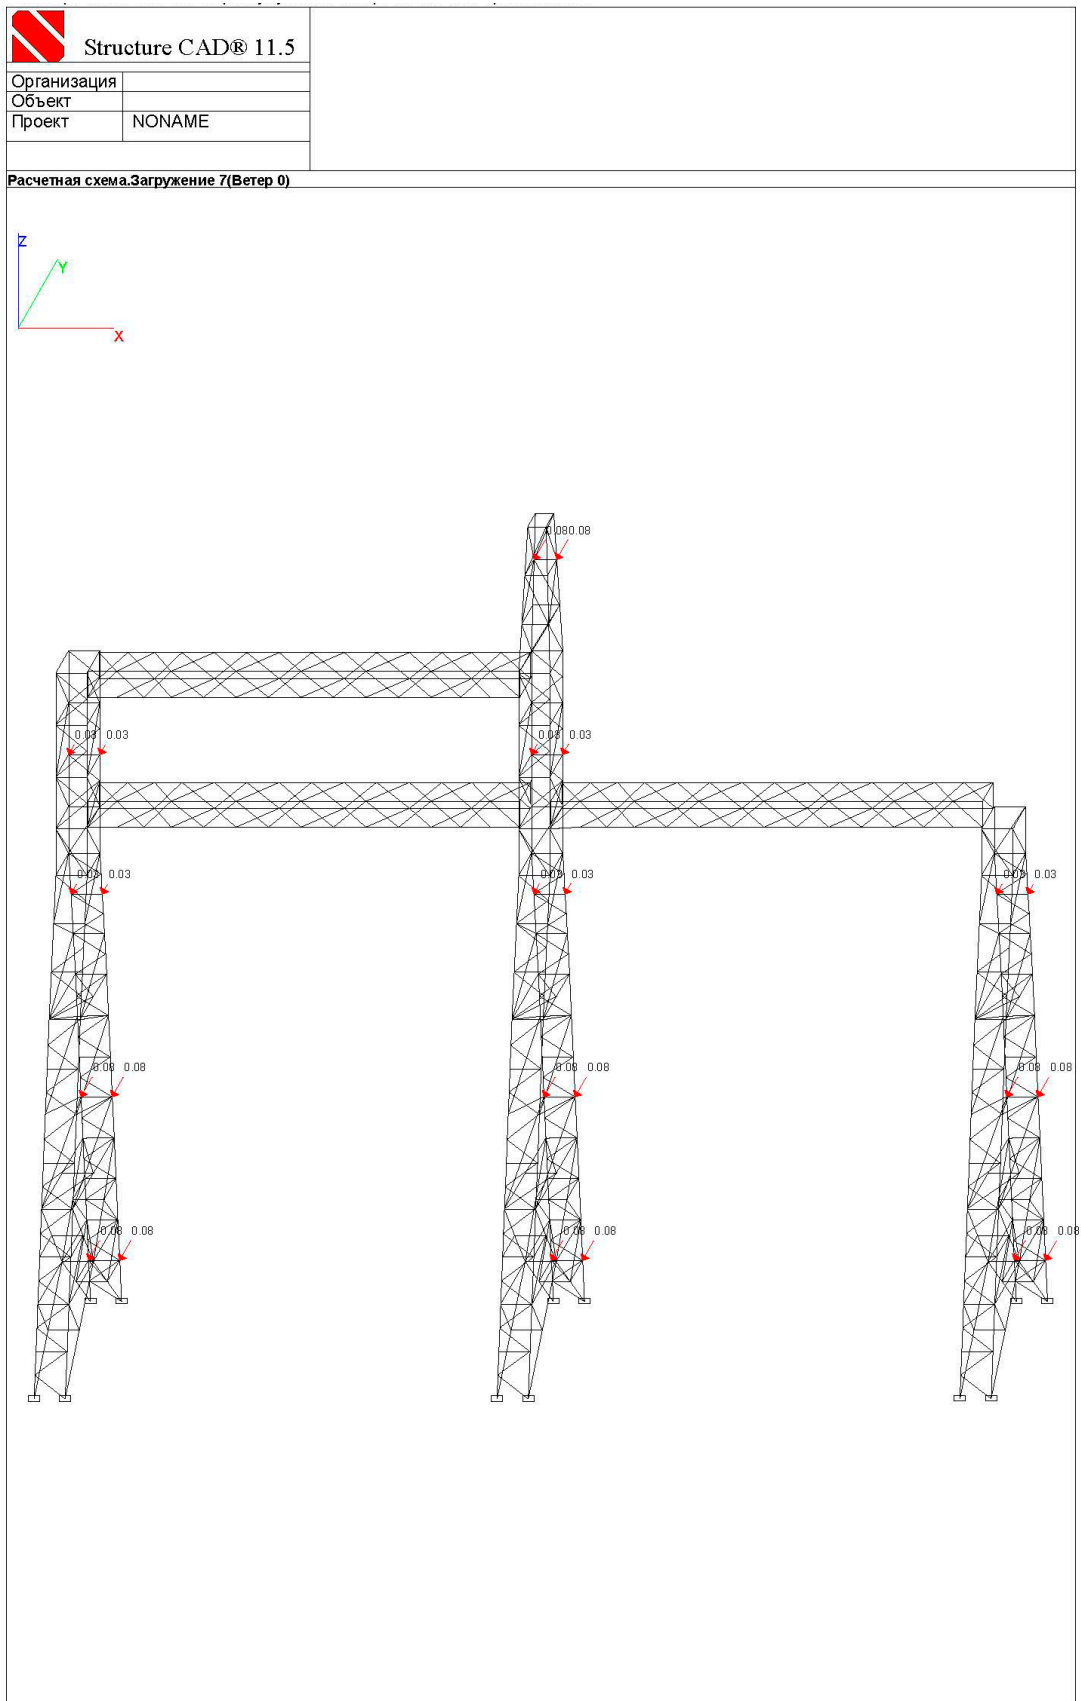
Ветровая нагрузка на конструкцию вдоль оси ВЛ
